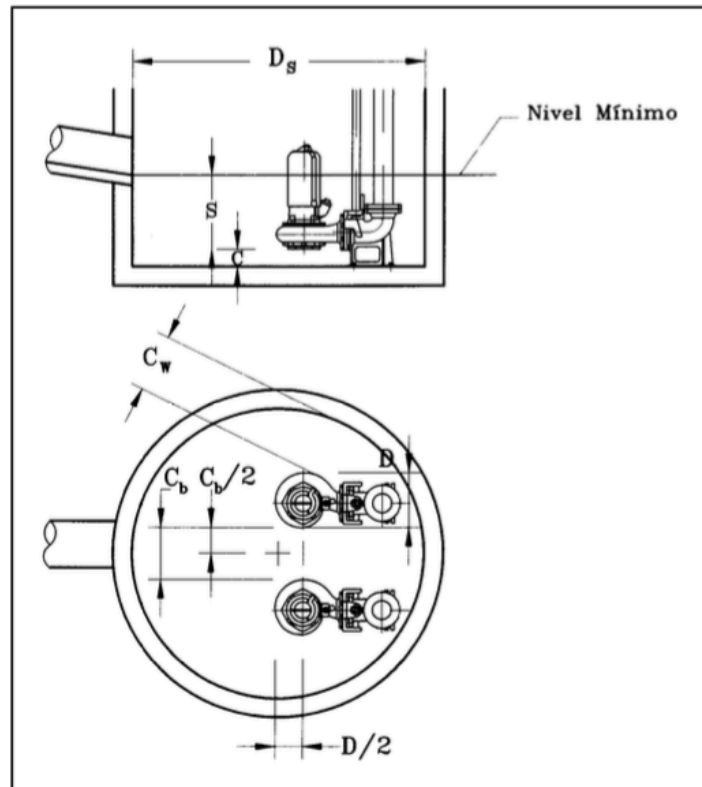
Recomendaciones para las dimensiones de pozo de planta circular (Fuente: ABS, manual para el proyectista)
